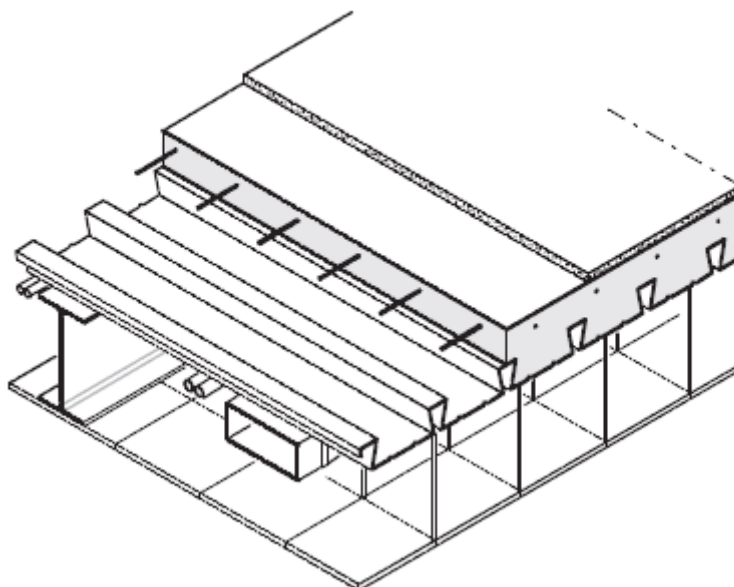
exemple d'un plancher avec faux plafond pour les conduites. [5]
